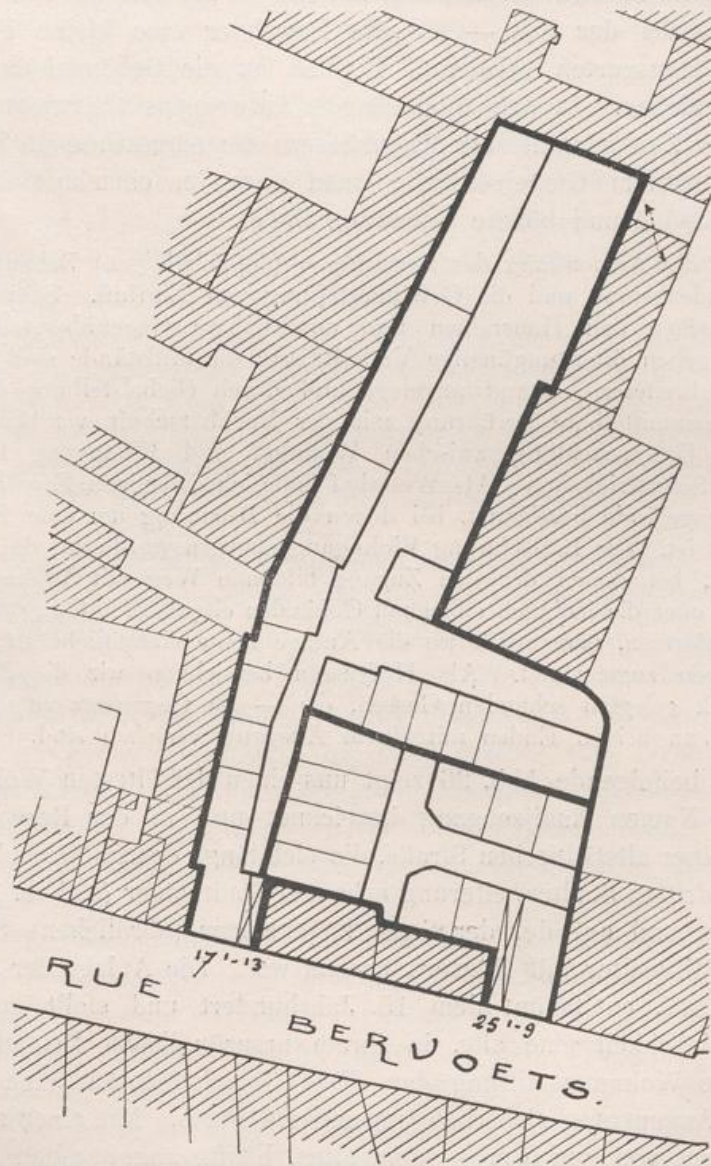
Wohnang in der Bervoetsstraat (Radijzengang), Grundriß.
